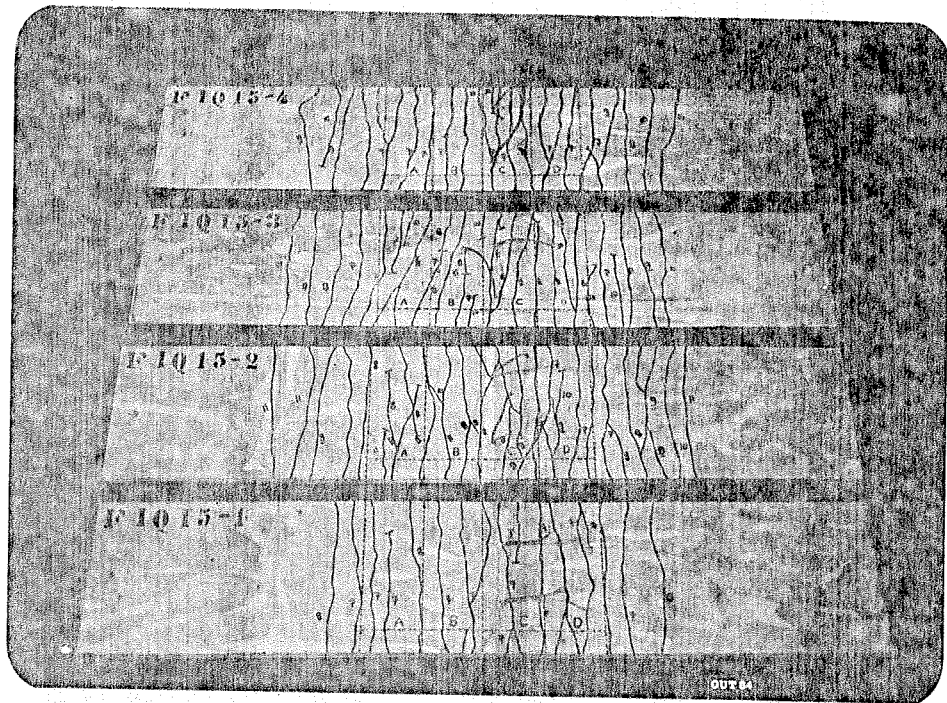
Fissuração final - SERIE F1015
